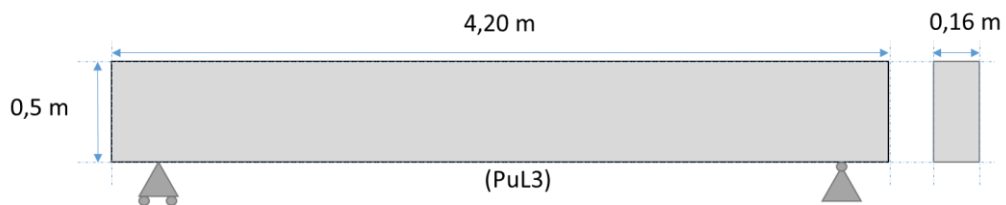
Présentation de la poutre « PuL3 » (la poutre est actuellement installée sur sa fibre supérieure i.e. la partie normalement en compression) (chantier de Lyon)
